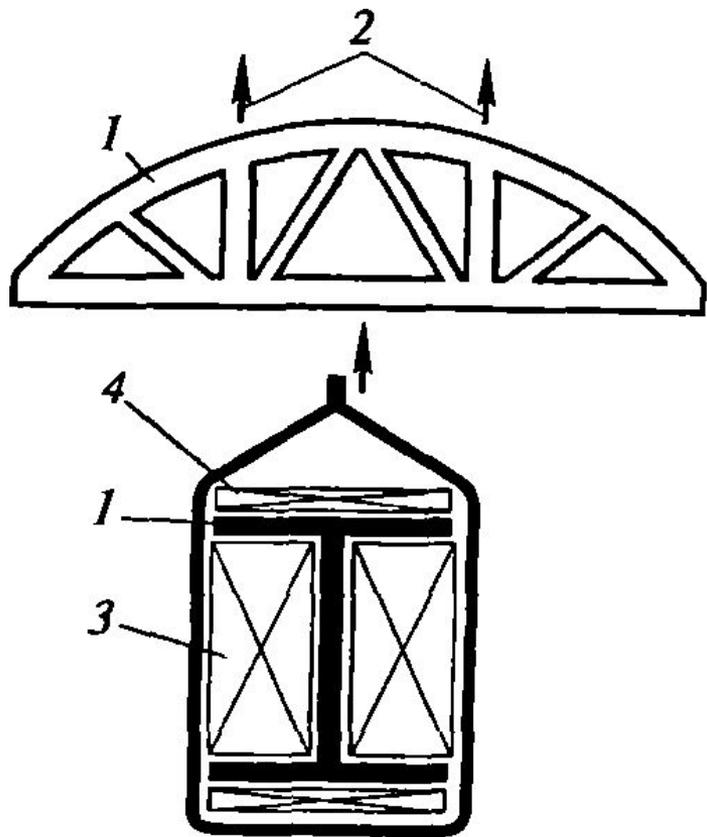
Усиление поясов металлической двутавровой фермы перед подъемом:
